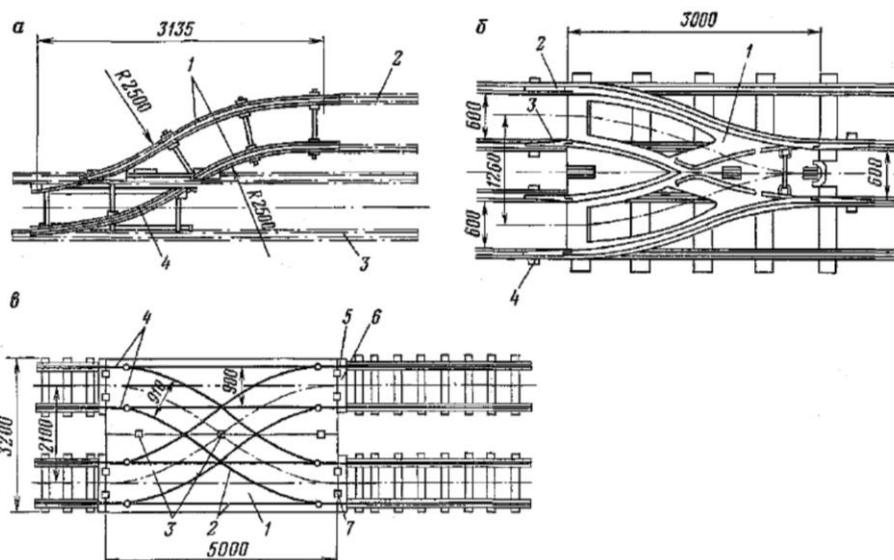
Обменные устройства для вагонеток: а – накладная стрелка; б – накладная плита-разминовка; в – накладная двухсторонняя плита-разминовка
